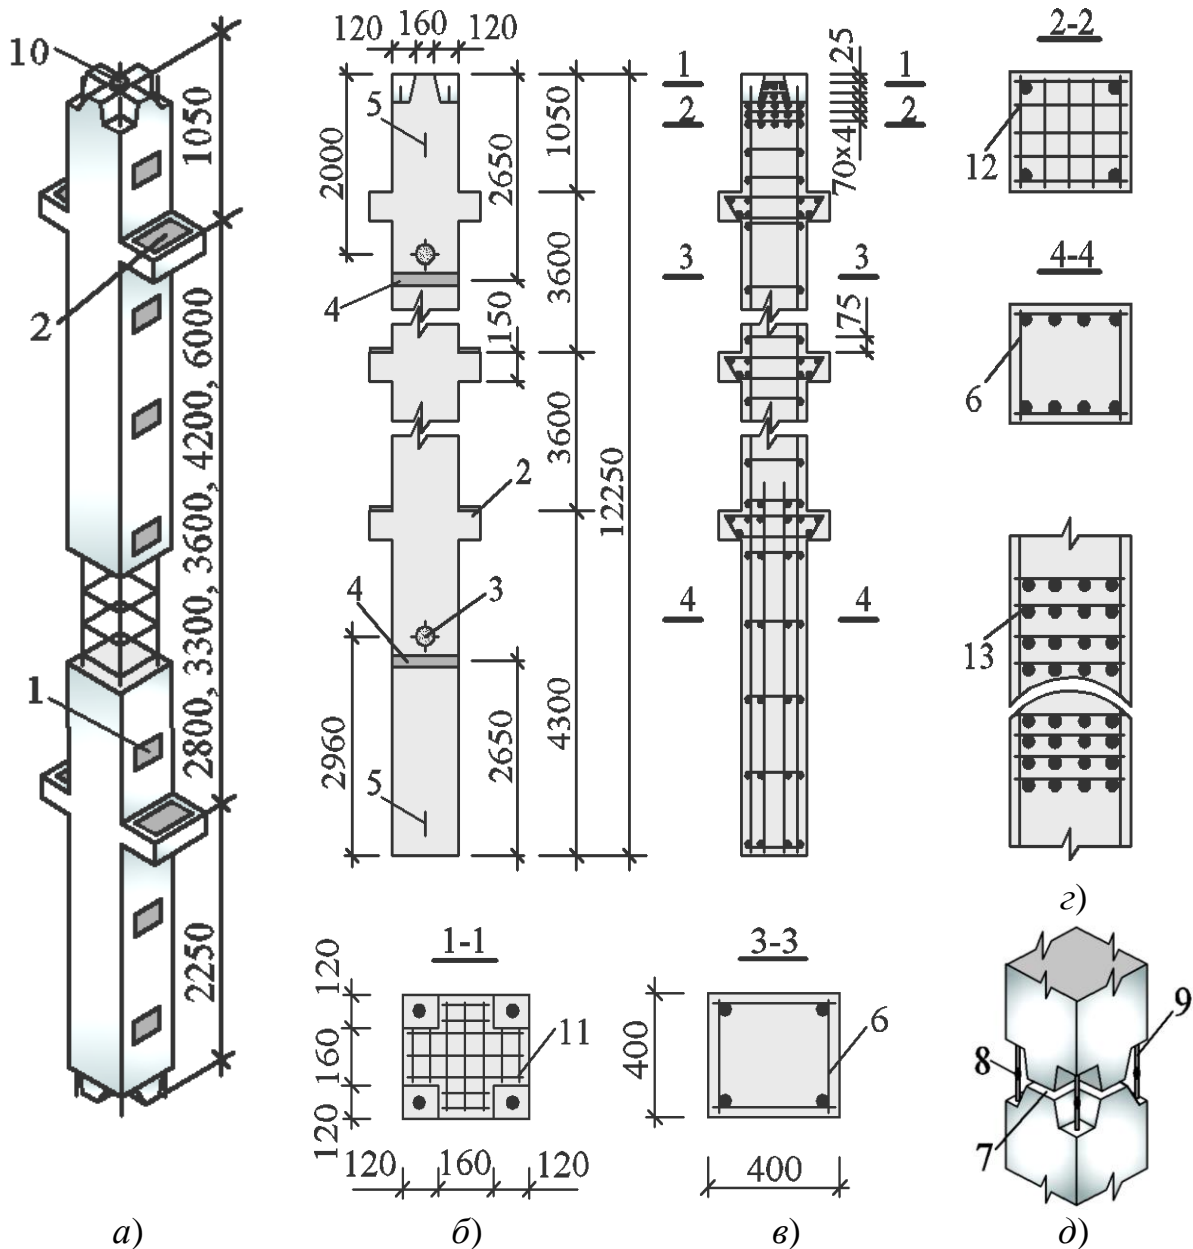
Залізобетонна збірна колона багатоповерхової будівлі із в'язевим каркасом:
